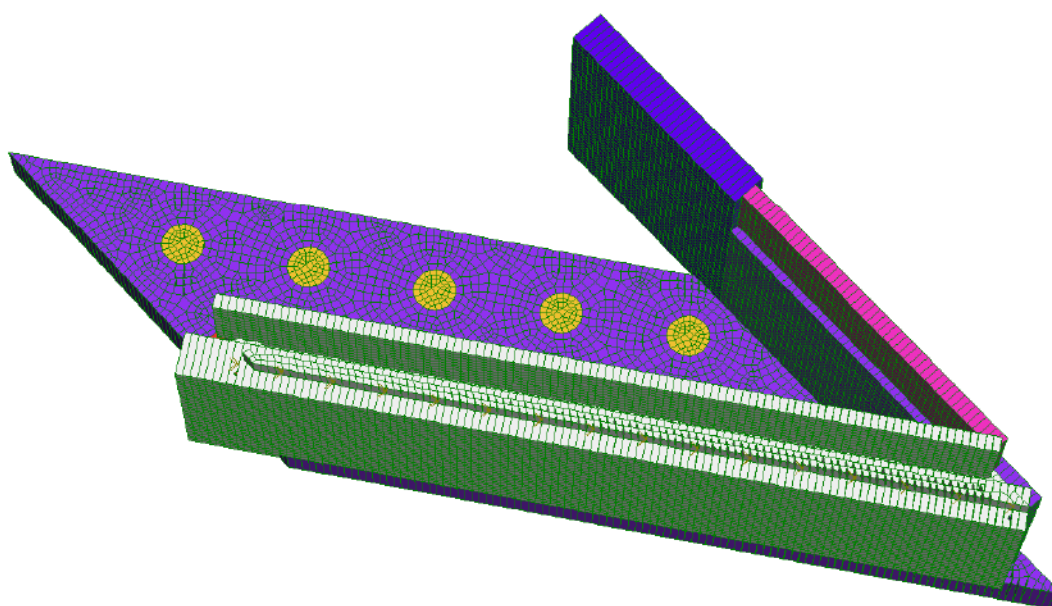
Modello con platea - Vista tridimensionale fronte - Spalla 1
